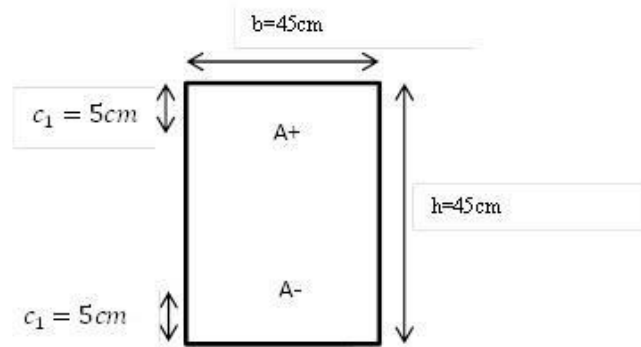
Section rectangulaire compression E.L.U
